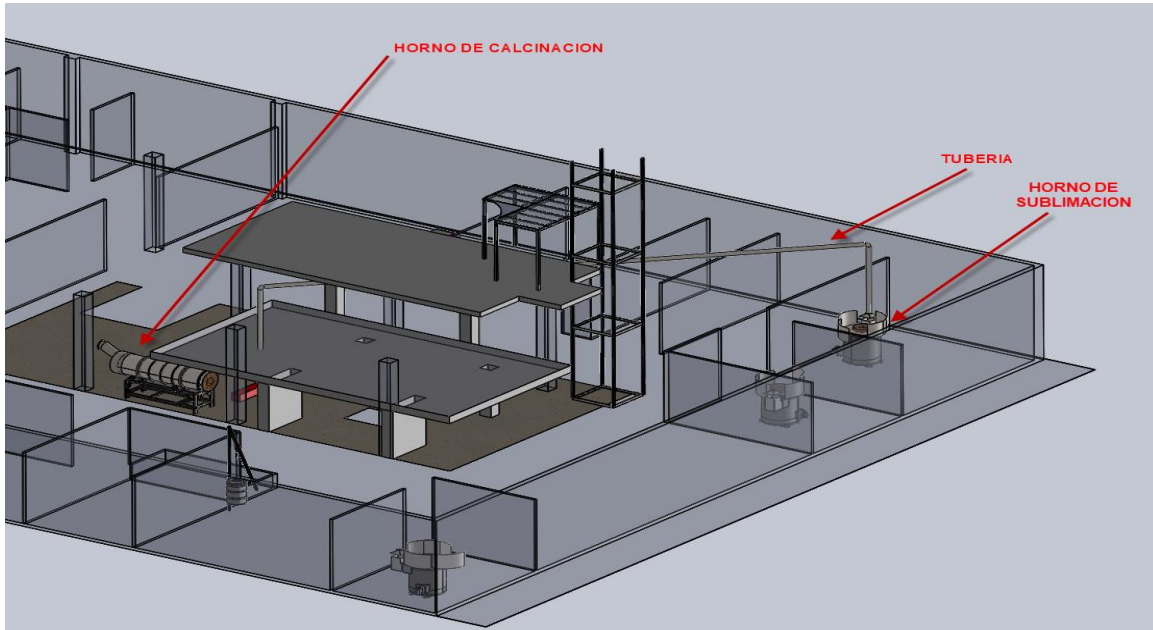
Plano de la tubería para la conducción de calor entre los hornos (Esquema suministrado por industrias EMU. S.A.)
